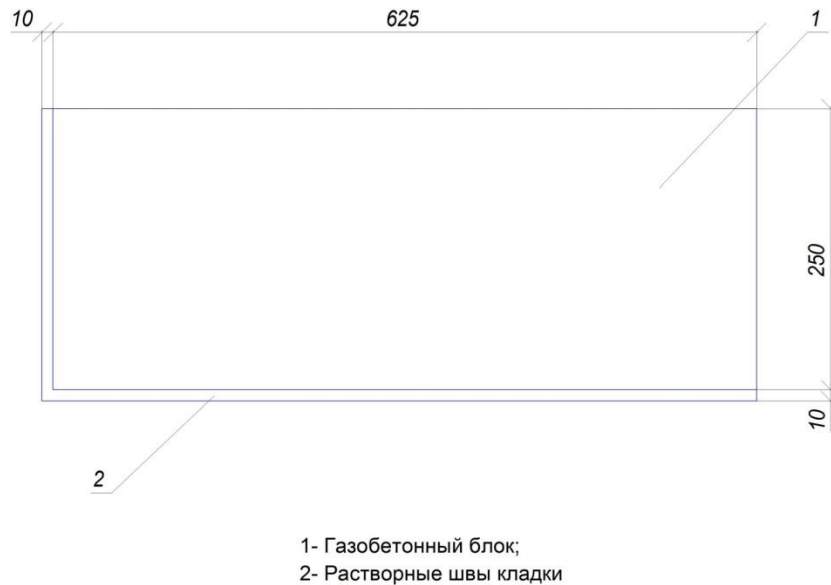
Схема регулярно повторяющегося элемента стены из газобетонных блоков со швами на цементно-песчаном растворе
